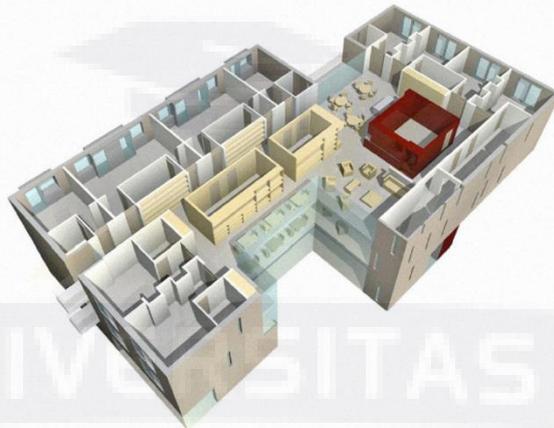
Lantai dasar *House Elderly Care Facility
